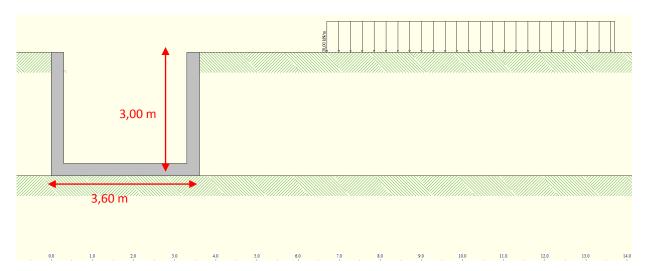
Schematizzazione della sezione di calcolo Pozzetto imbocco
